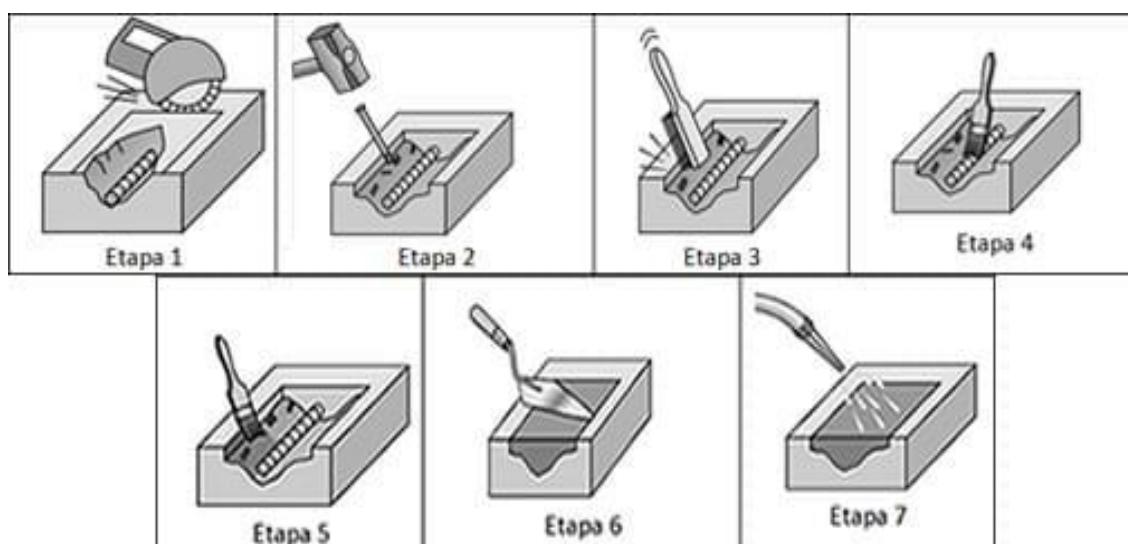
Etapas para recuperação de armaduras corroídas
